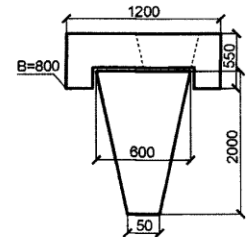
Пірамідальна пая із збірним залізобетонним оголовком.
